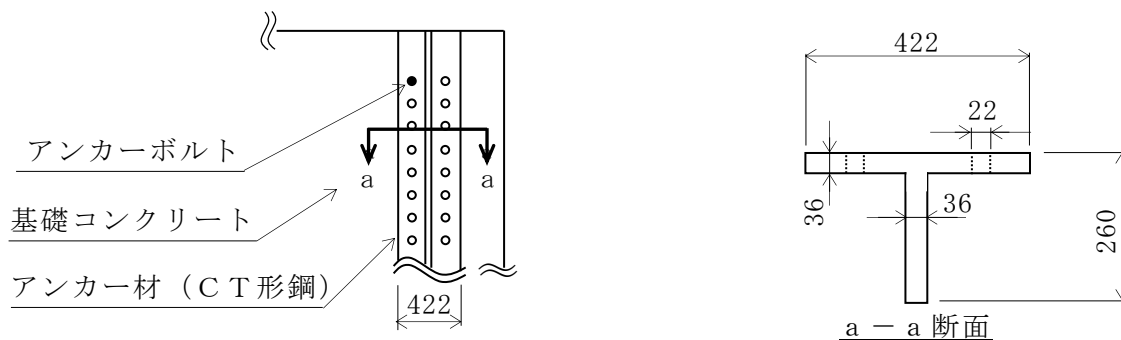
アンカー材（C T形鋼）の概要図（単位：mm）
